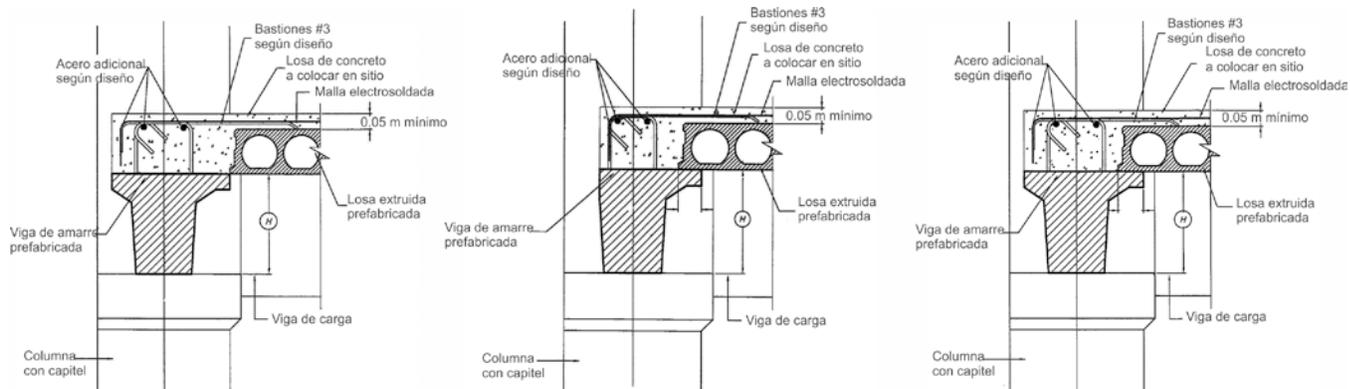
Secciones B-B, opciones 1, 2 y 3 de conexión viga de amarre lateral - entrepiso
